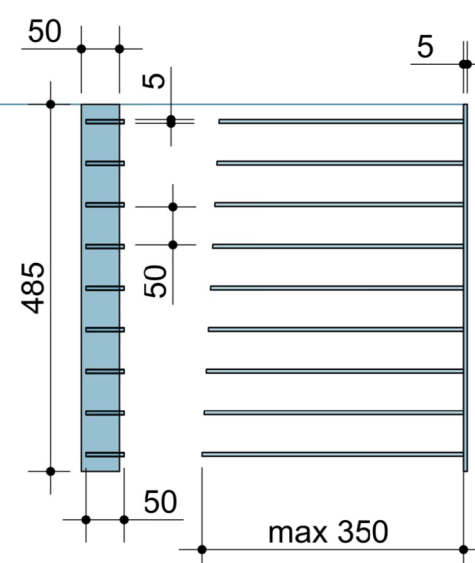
DETAIL ANSCHLUSS GELÄNDERTHÜLLE
